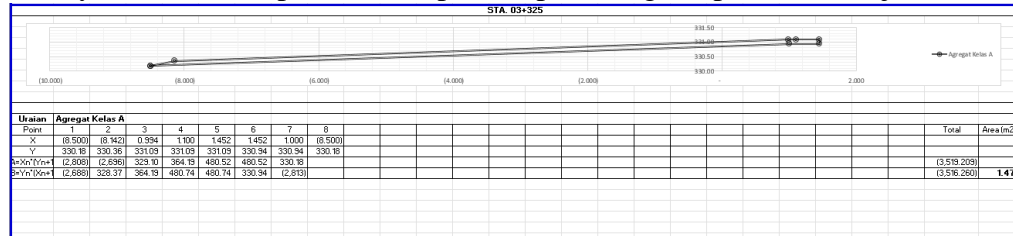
Letak Koordinat Lapis Drainase Jalan Ramp 3 STA 03+325
